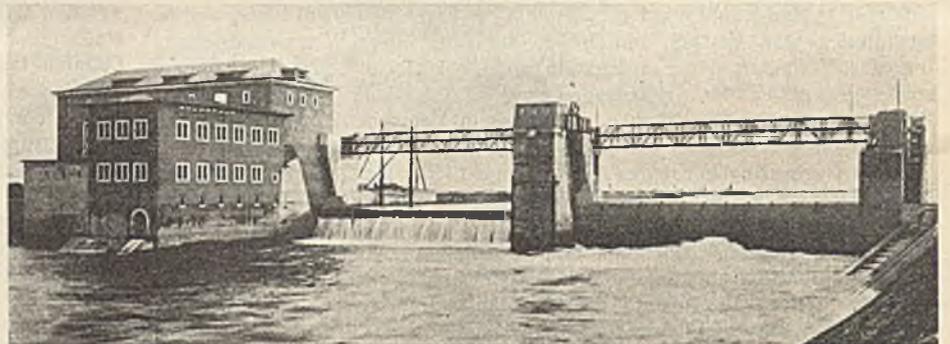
Wehranlage im Main bei Viereth. 2 um 1,10 m absenkbar Walzen, l. W. je 30 m, H. 6 m.
